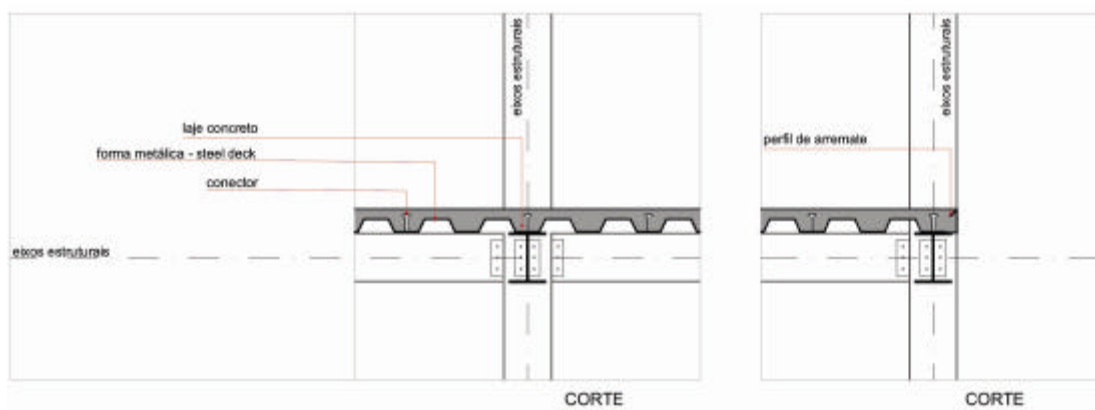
Detalhe construtivo – laje forma – steel deck.
